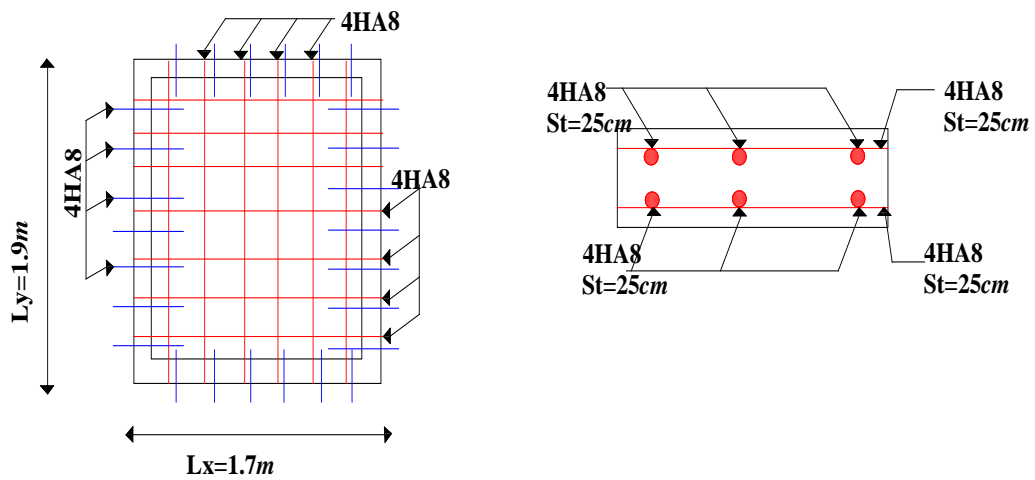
Schéma de ferrailage de la dalle ascenseur
